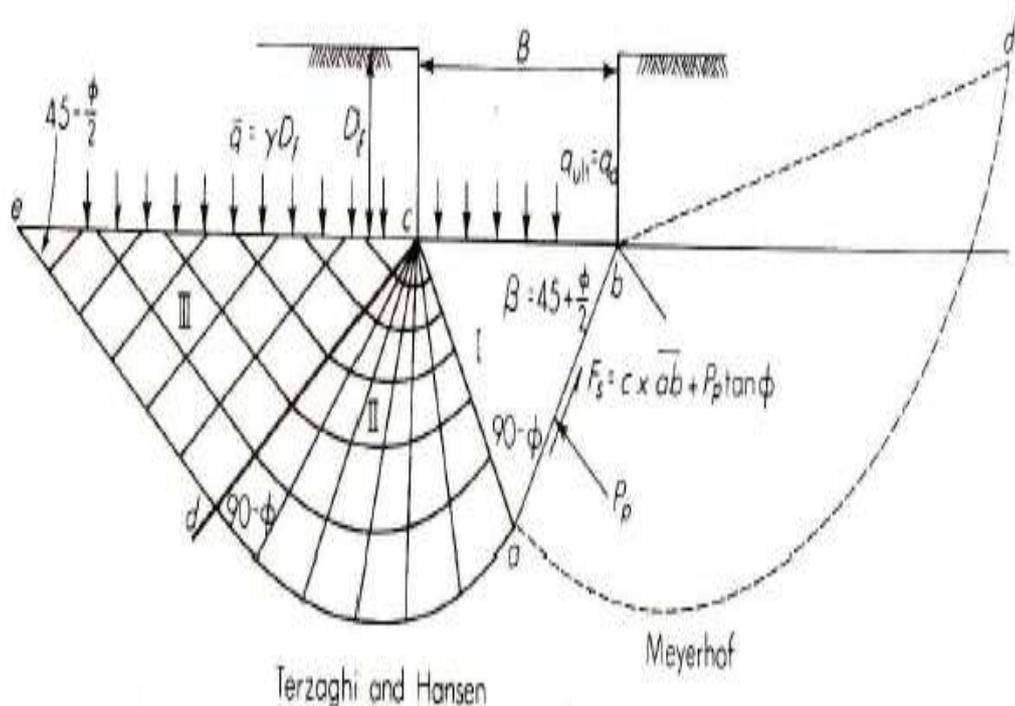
Gaya yang bekerja dalam suatu sistem pondasi
